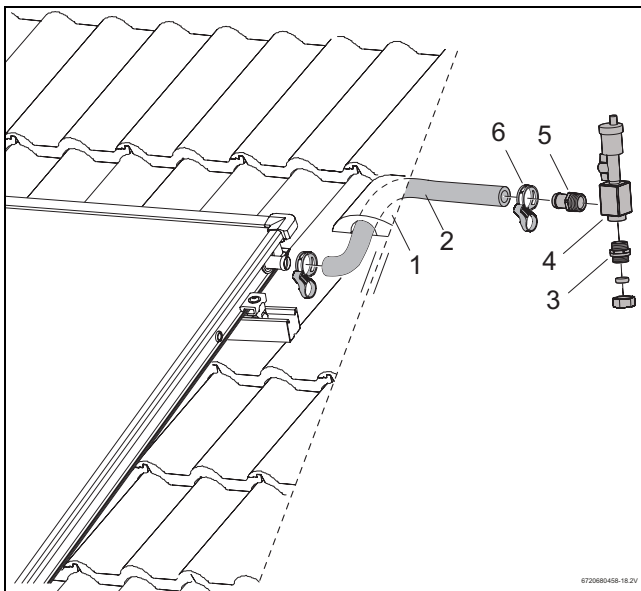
Montaje del tubo solar a la conexión de impulsión
